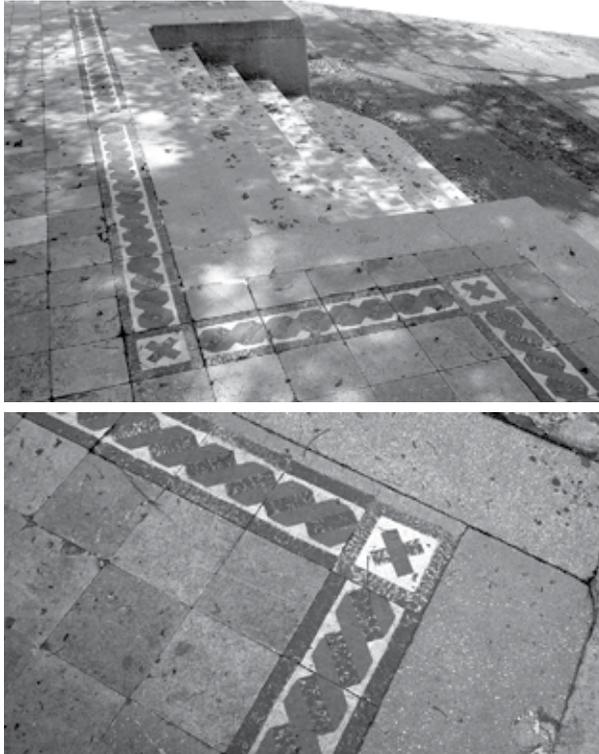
Detalle de pavimentos de pasta en plataforma de desplante y el perímetro de terrazo, 2014. Archivo Alejandro Leal.
